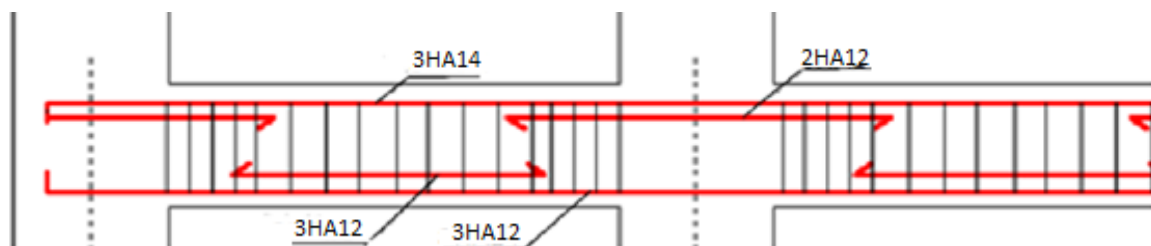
Disposition constructive des armateurs dans les poutres.
